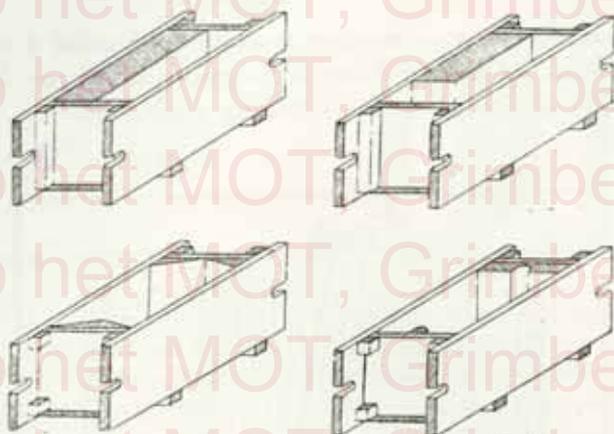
Un moule peut servir à la confection de blocs en béton de moindres dimensions.
